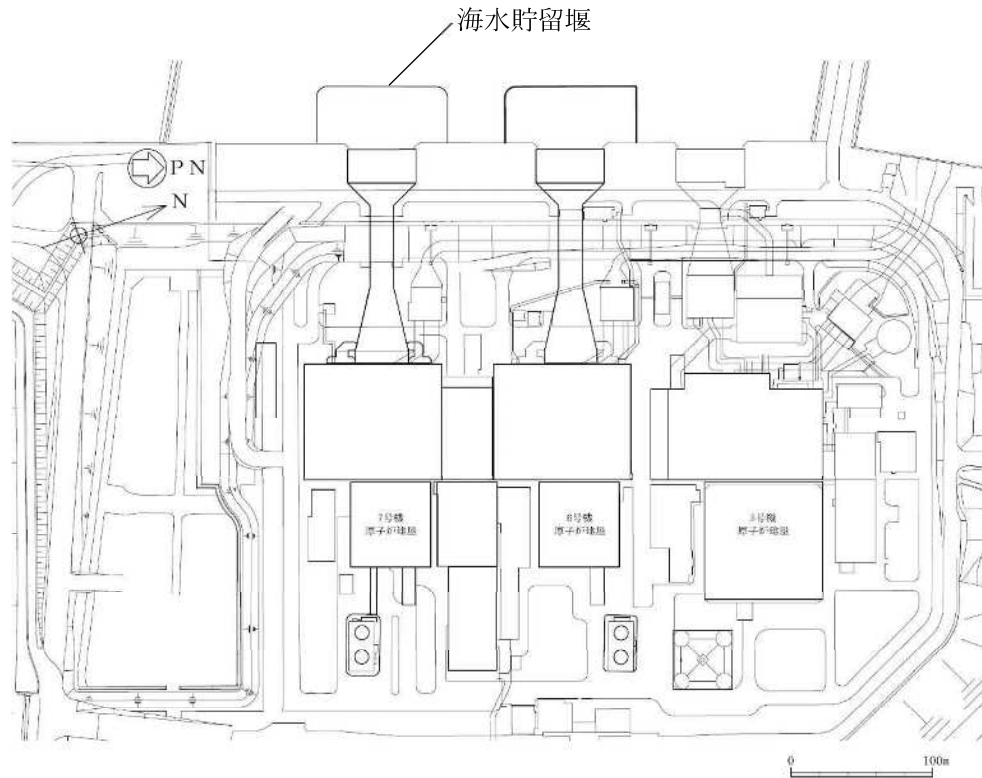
(1) 海水貯留堰の位置図（全体平面図）
